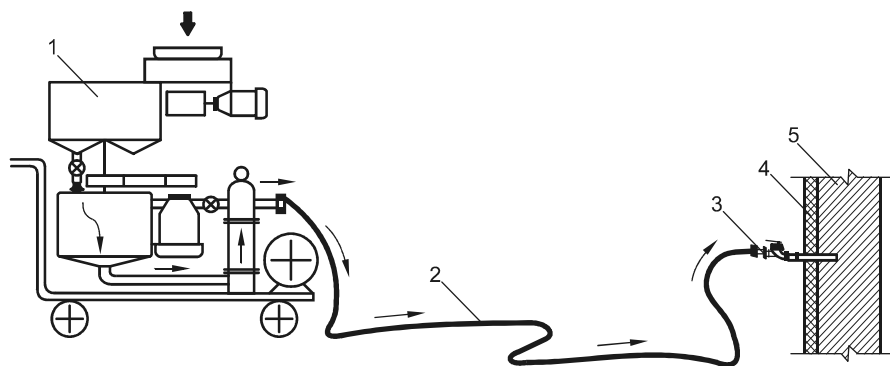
Схема инъектирования отверстий при анкеровке плит к наружным стенам (стрелками указано направление движения раствора): 1 — инъекционный агрегат; 2 — шланг; 3 — инъектор; 4 — пенополистиролбетонные плиты; 5 — наружная стена
